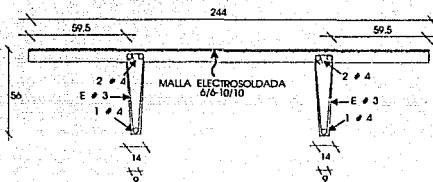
SECCION DE REFUERZO DE LAS "DOBLES T"
